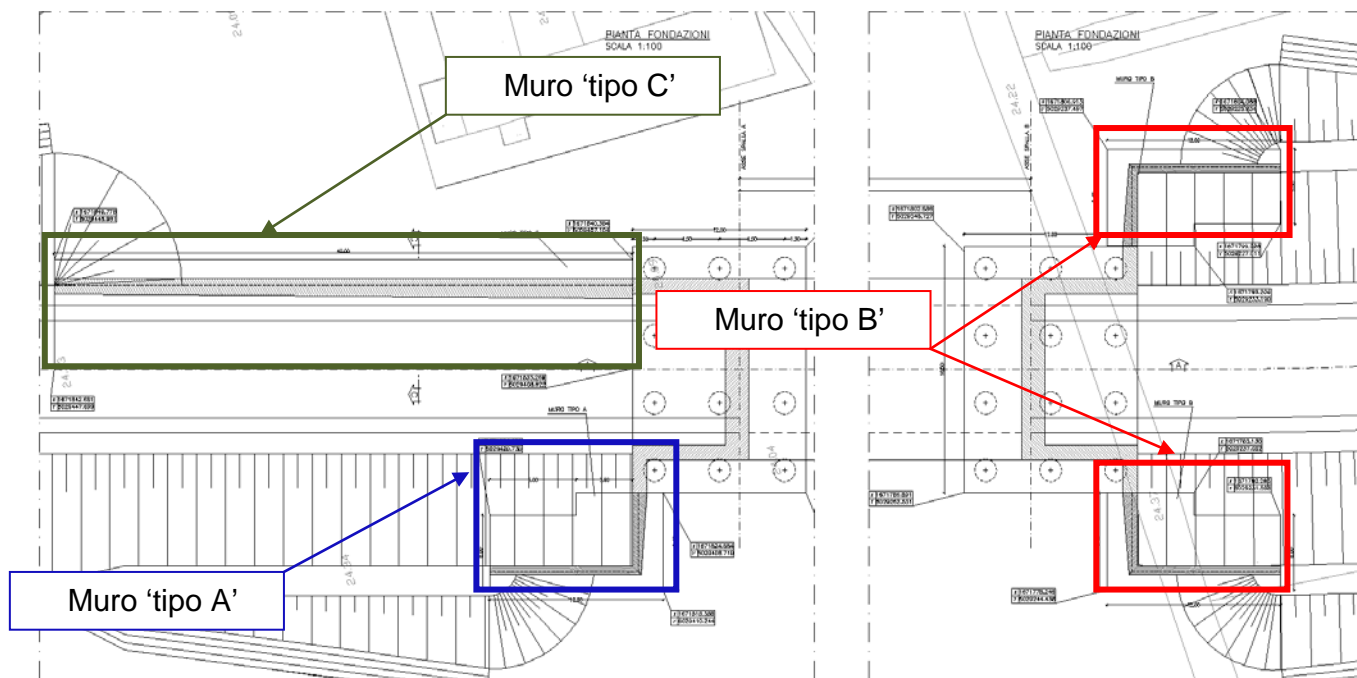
Stralci planimetrici: ubicazione muri in c.a. lato spalla A e lato spalla B
